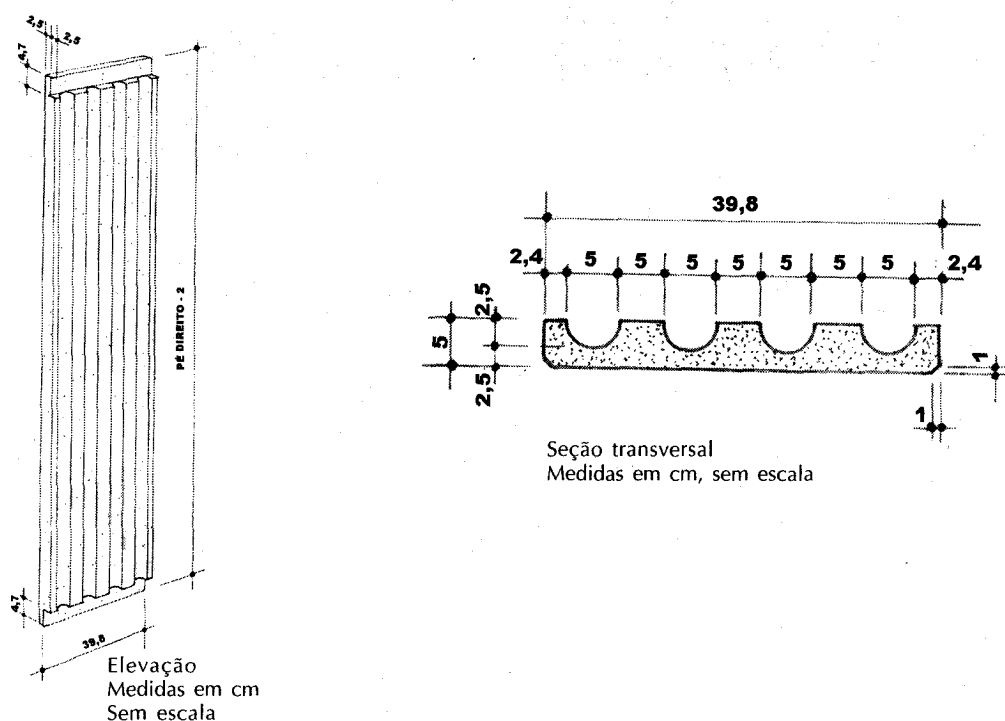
Elevação e seção final do painel utilizado para o subsequente desenvolvimento do método construtivo de paredes de GRG, em campo
